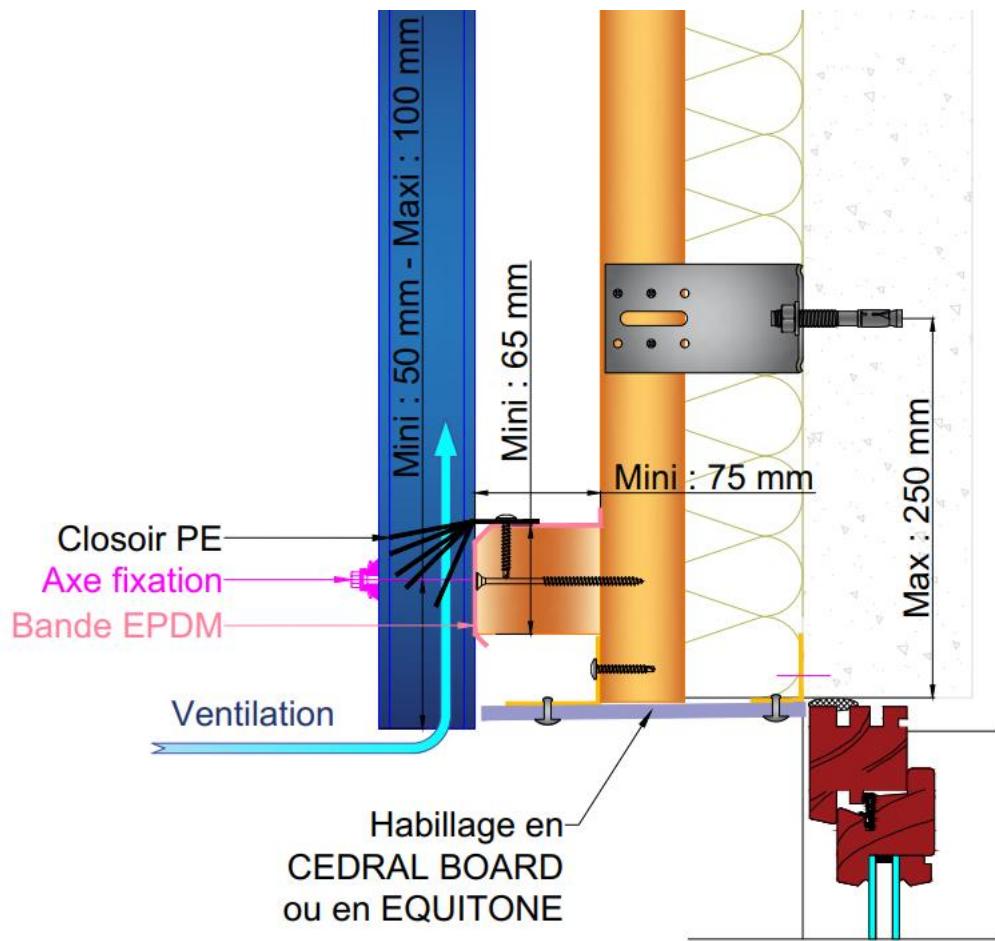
Linteau de baie avec panneau CEDRAL BOARD ou EQUITONE
